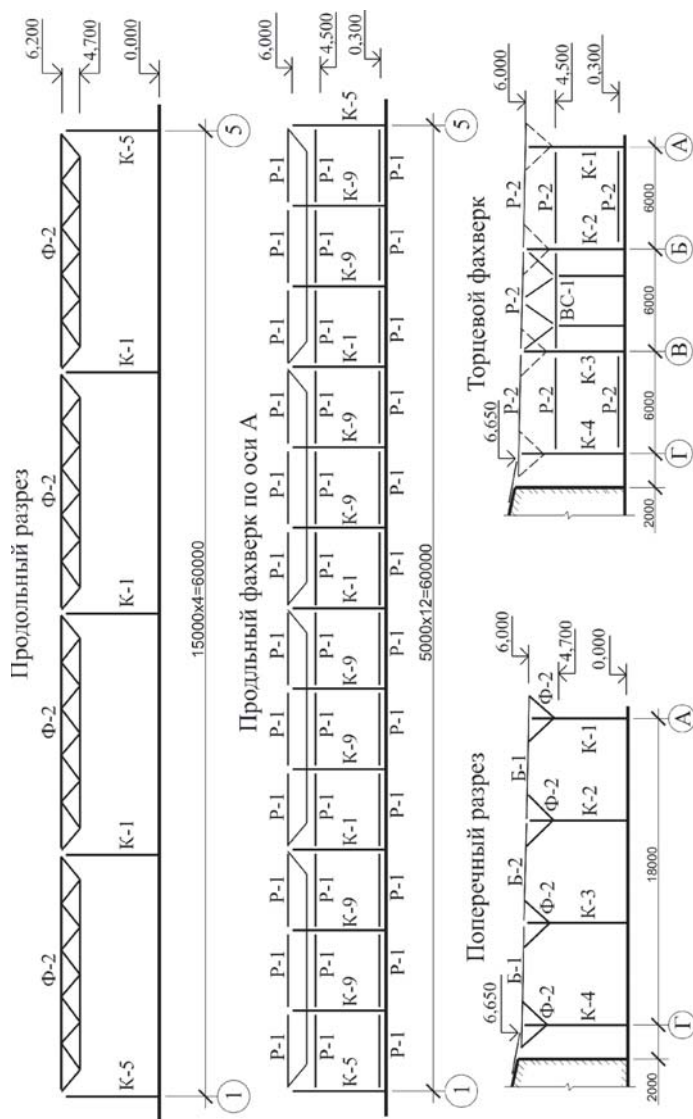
Разрезы по каркасу (покрытие с фермами пролетом 15 м)
